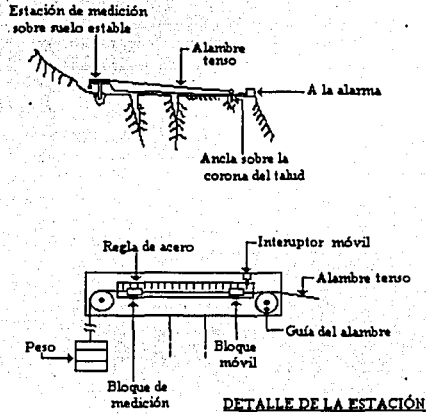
Medidor de grieta mecánico.
